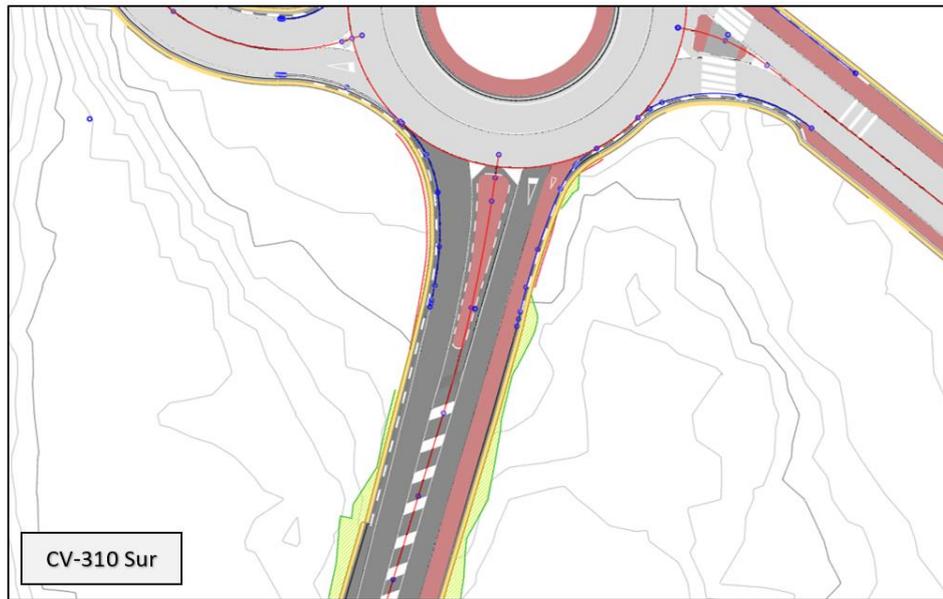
Detalle de glorieta - Situación actual CV-310 (Acceso Sur)
